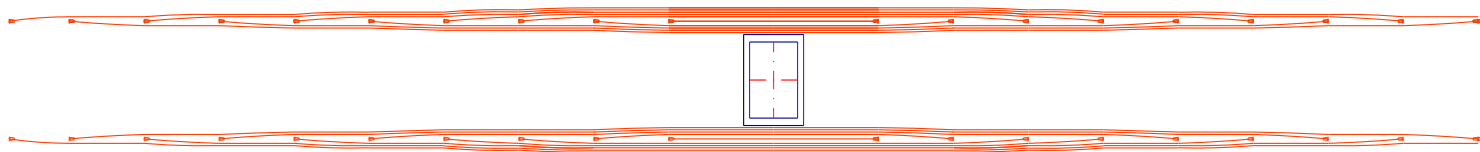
Trazado de los cables de pretensado superior o de voladizo para uno de las 4 secciones del puente. (Todos iguales).
